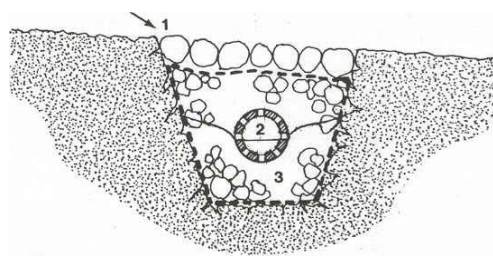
Alimentación superficial, 2.- Tubería perforada de rebase, 3.- Relleno.
